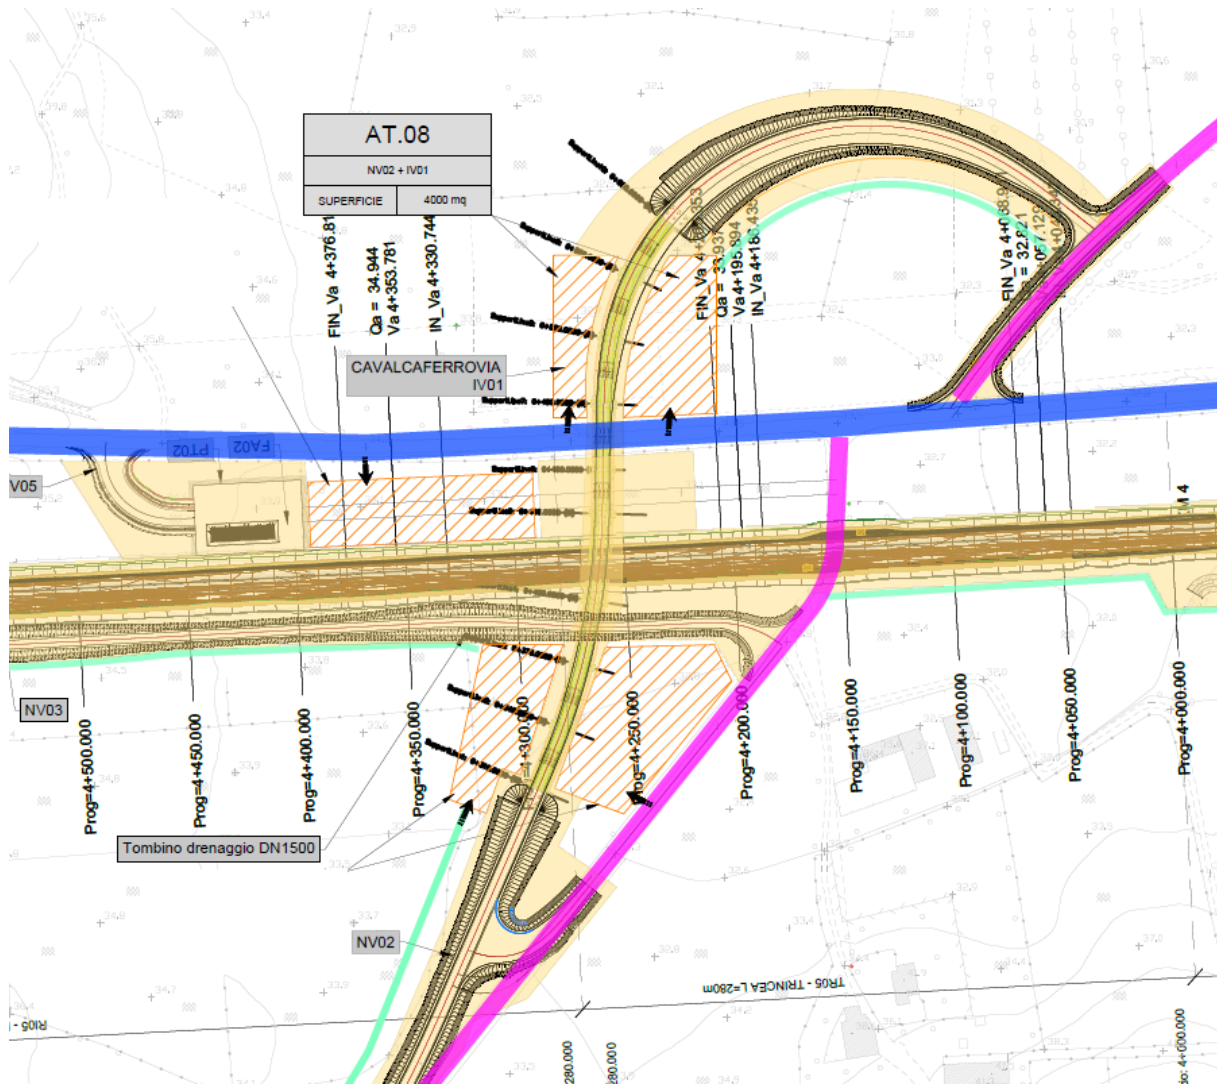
Vista in pianta dell'area di cantiere AT.08
